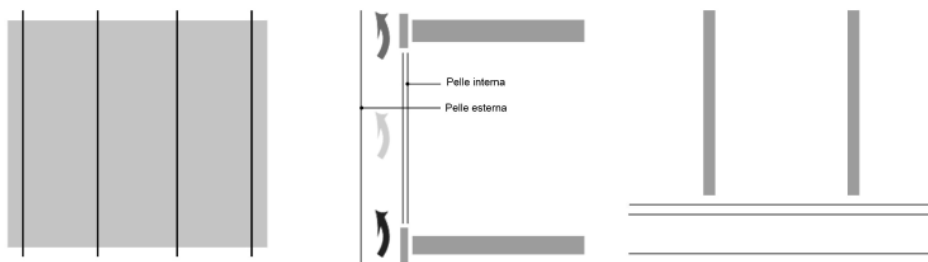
Sistema di ventilazione nelle "multistory facades"
